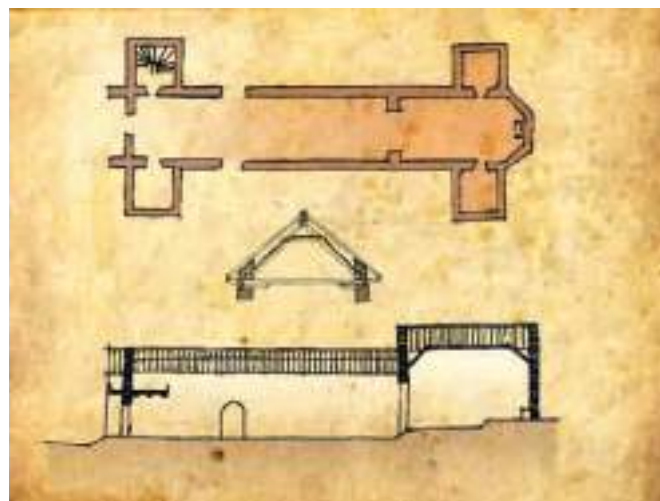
Detalle de la estructura de la cubierta, planta y corte del templo doctrinero prototipo. Dibujo: Diana Castillo Cerf.
